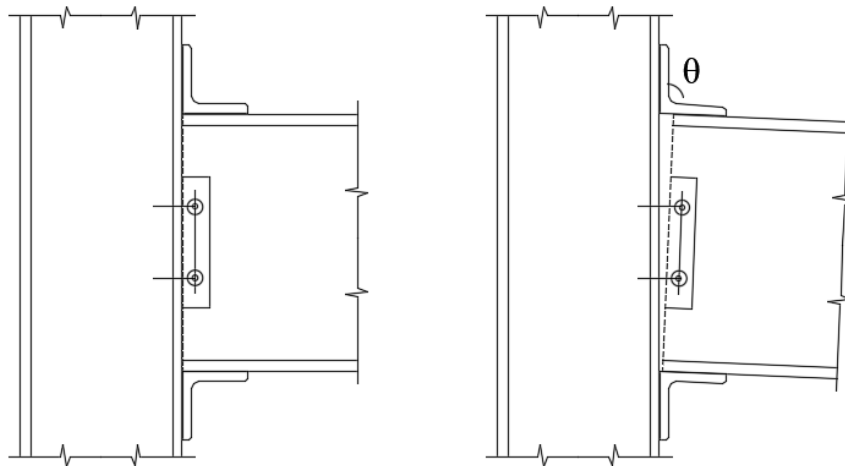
Detalle de conexión semi rígida a momento con restricción parcial de giro
